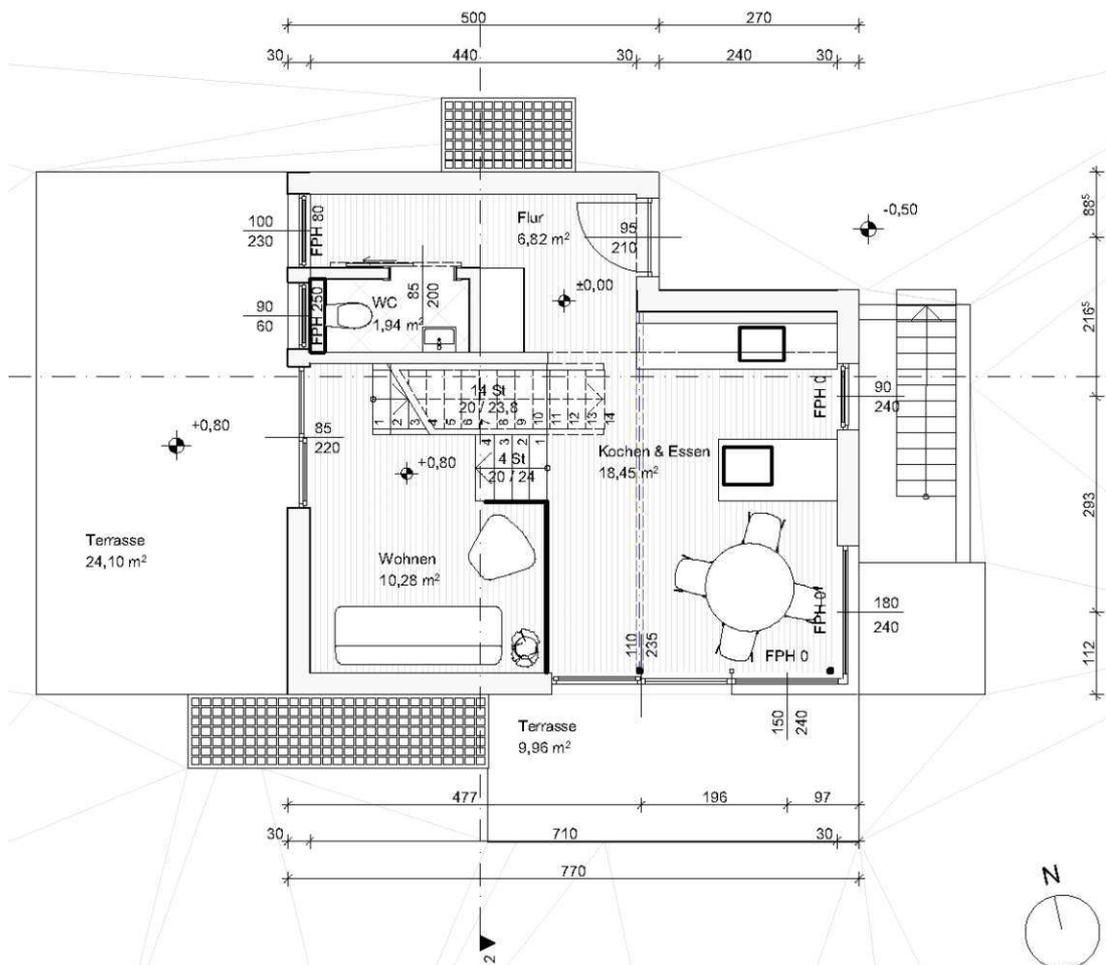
Grundriss Erdgeschoß 1:100 (eigene Abbildung)
